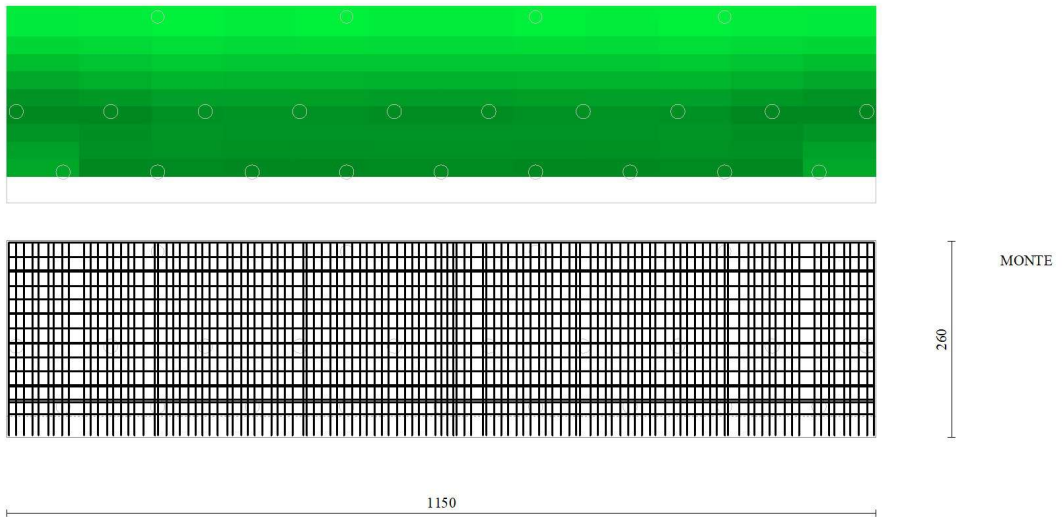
Piastra fondazione dir. Y (Inviluppo)
